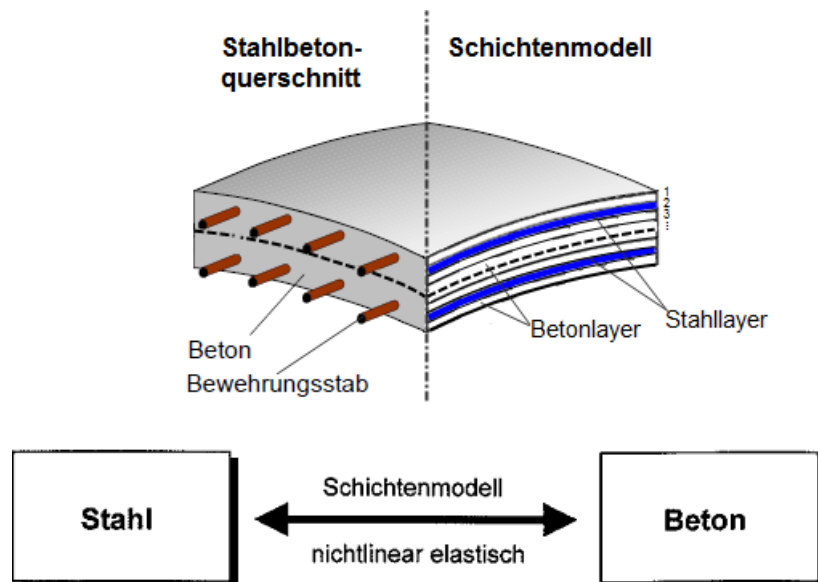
Schichtenmodell für Stahlbetonflächen
